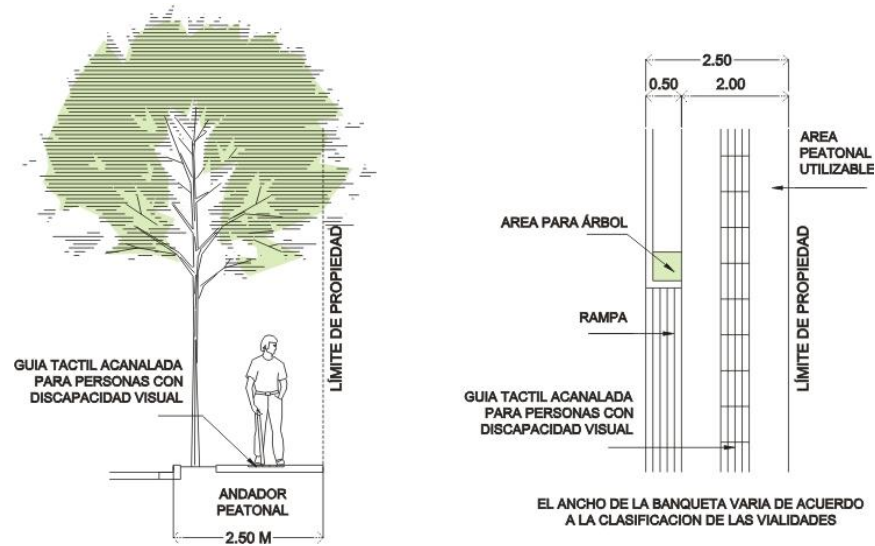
Detalle de banqueta de 2.50 metros de ancho
